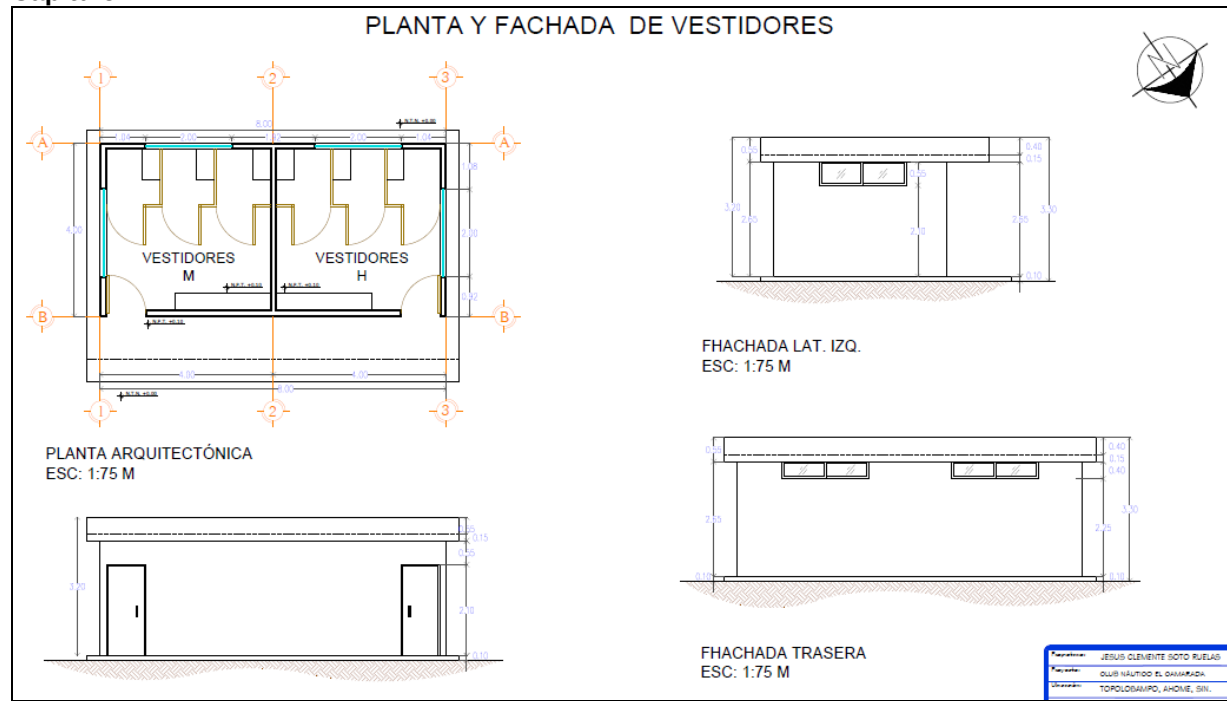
Dimensiones del área de vestidores. Ver detalles en Plano 5.
